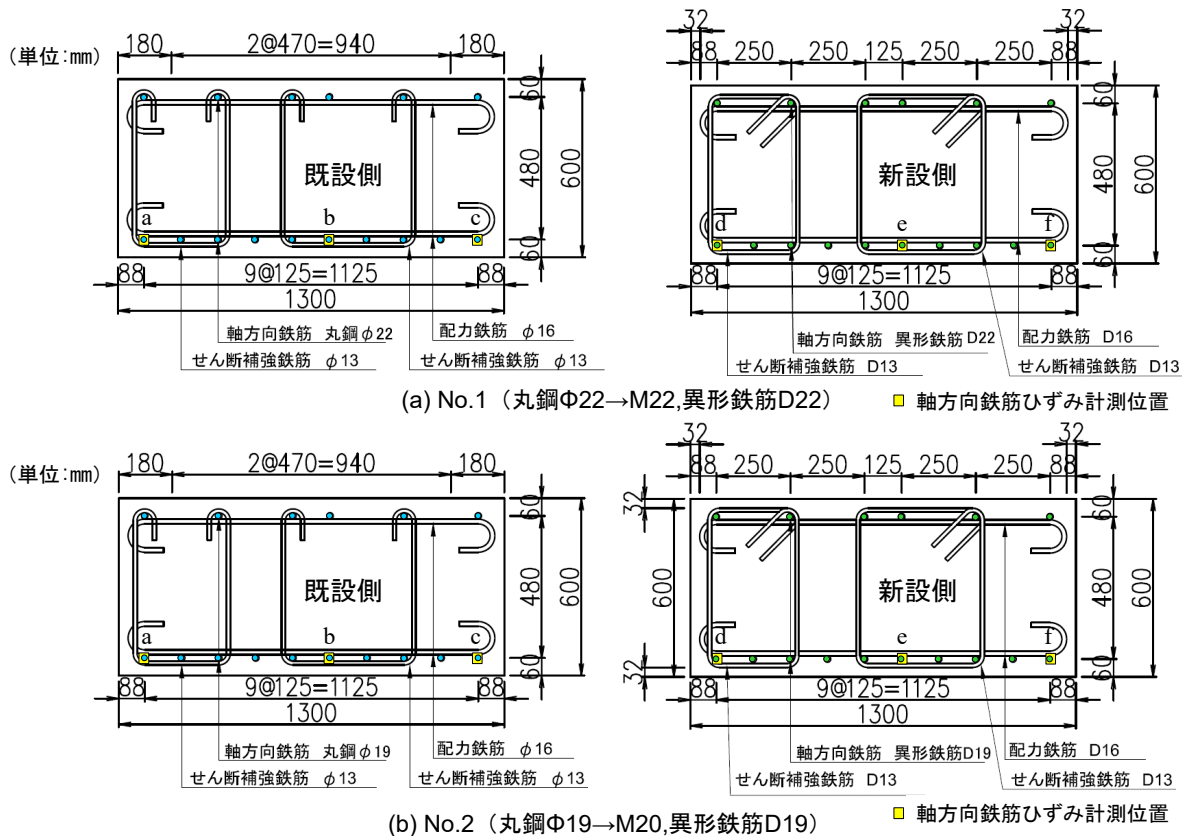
梁試験体の断面寸法 (断面図) と配筋の詳細
